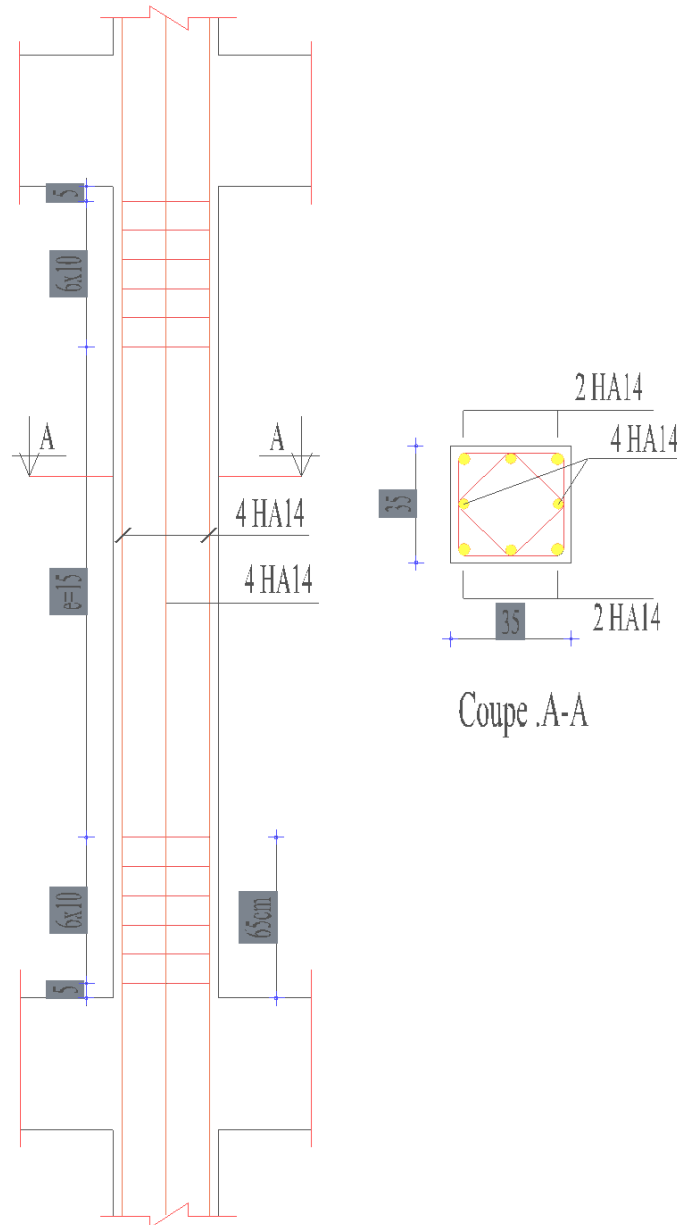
Schéma de ferrailage des poteaux (35 x 35)
